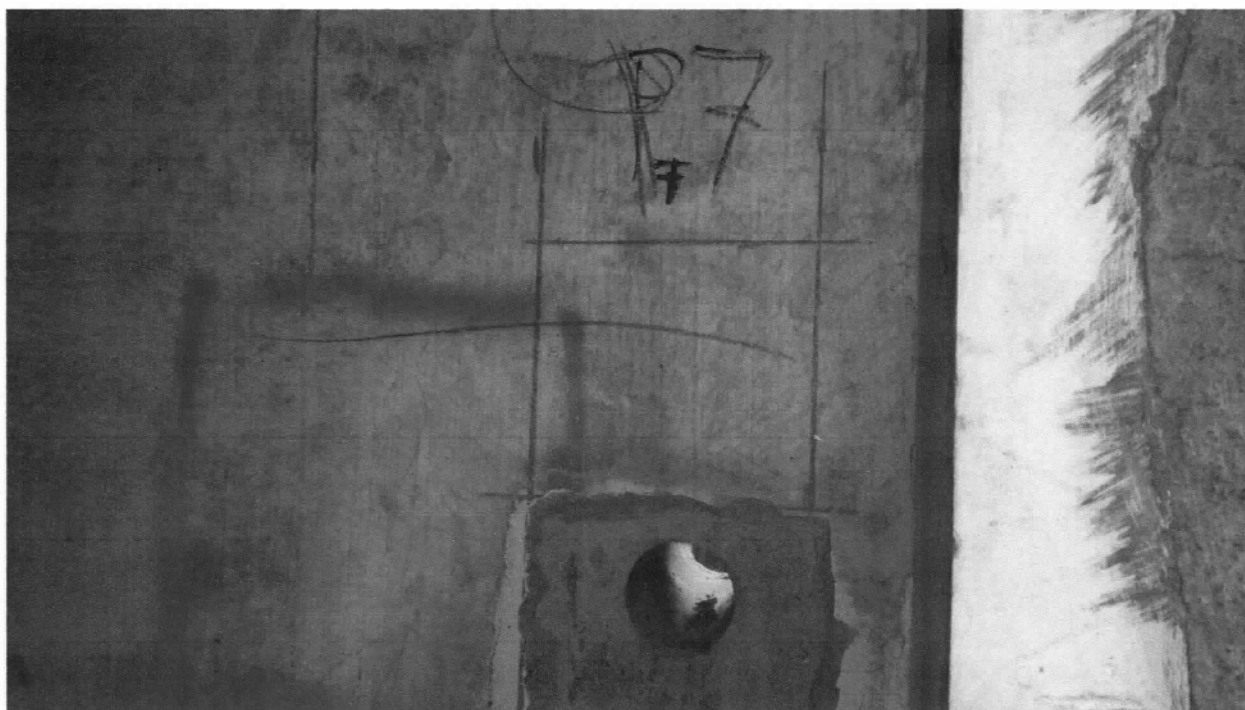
Estrazione di carota di calcestruzzo indurito da pilastro PT7
